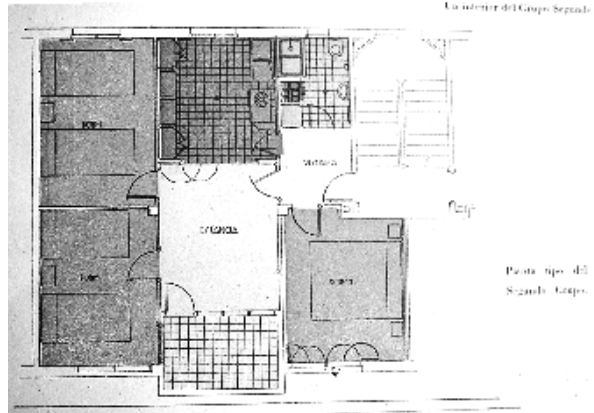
Planta de la vivienda de Solokoetxe II(1932). Pág. 2
